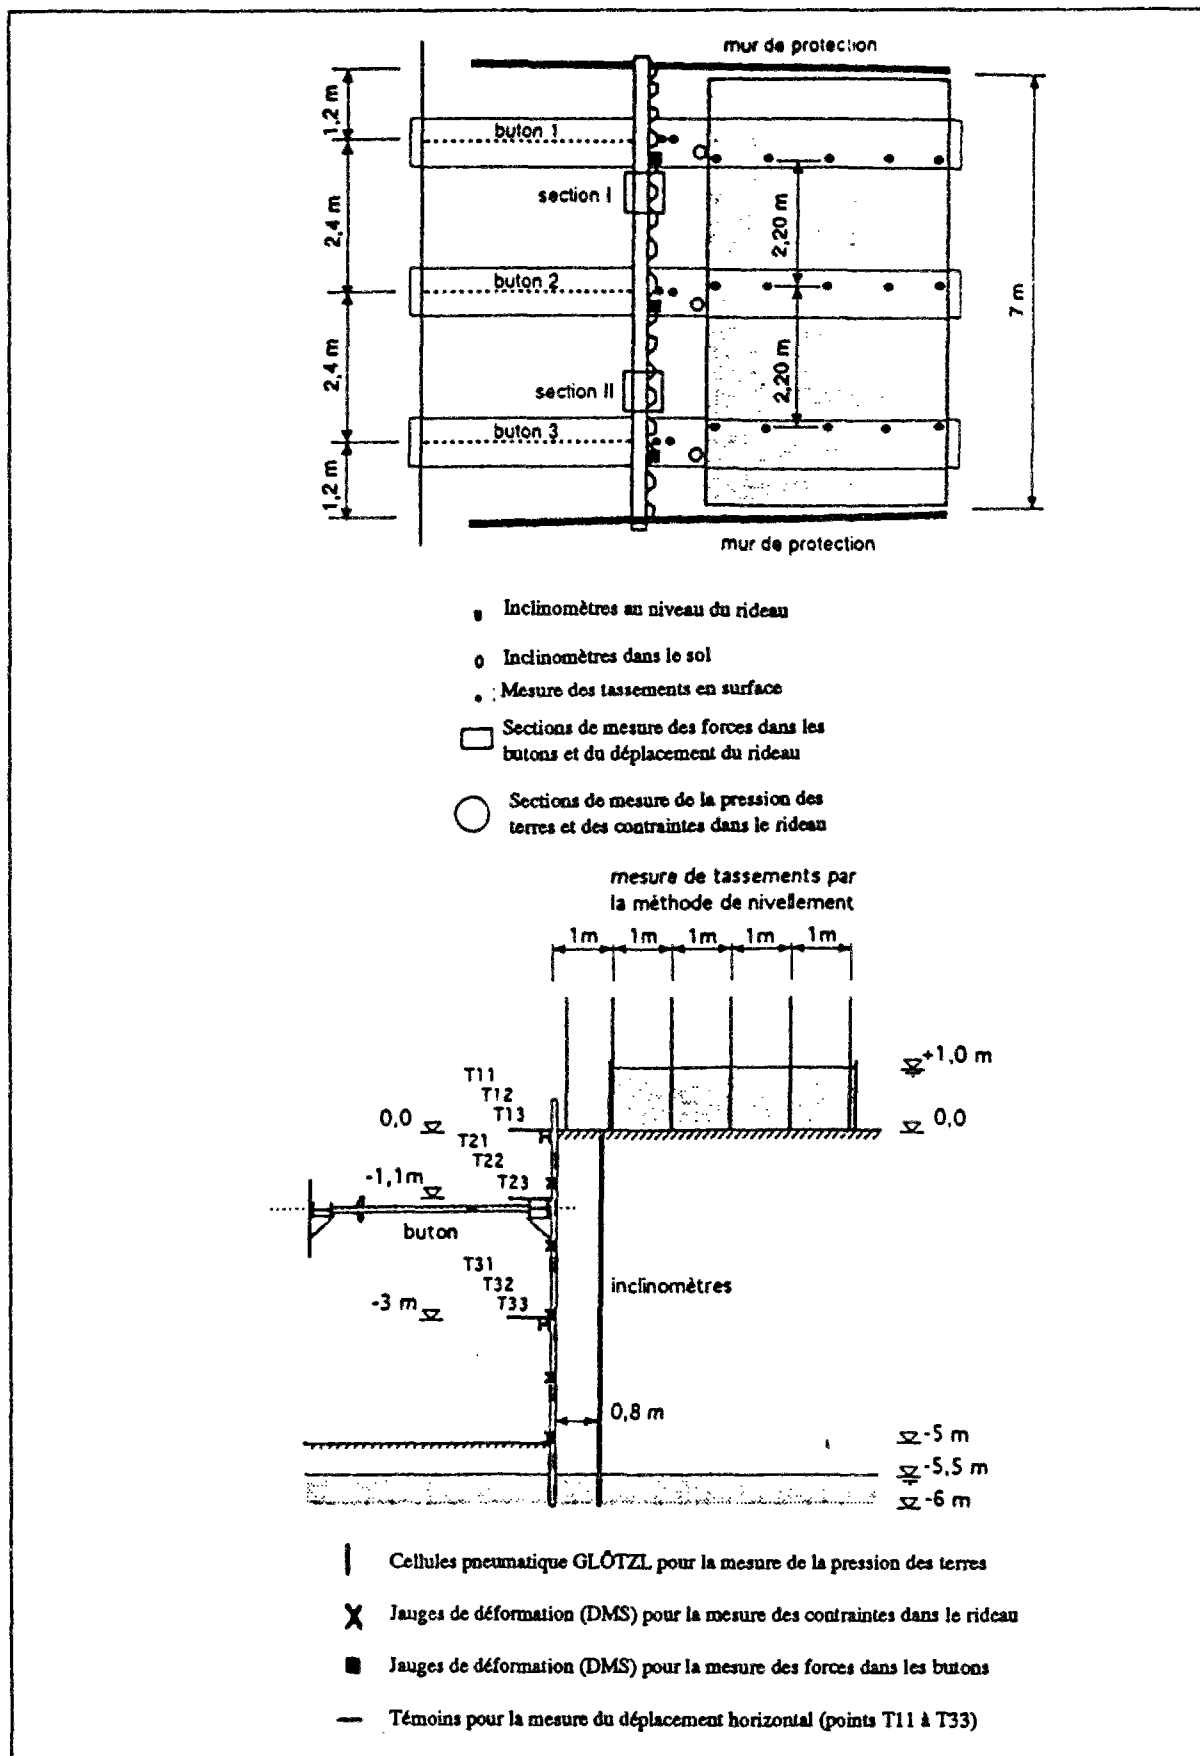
Dispositif de mesure : (a) vue en plan ; (b) profil transversal.
